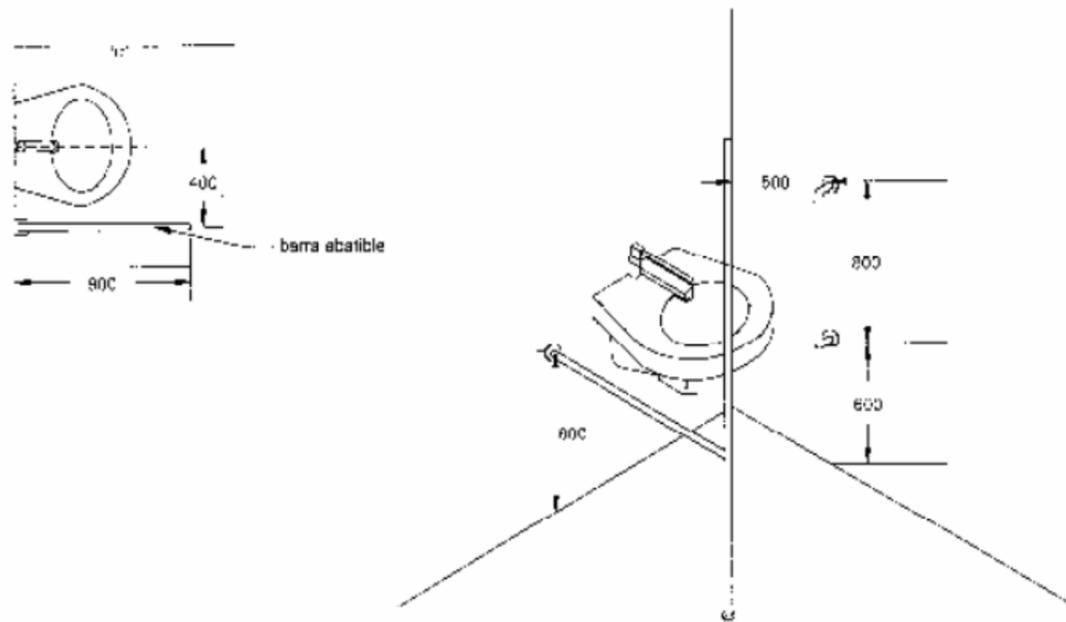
Barras de apoyo. Forma y disposición (Dimensiones en mm)
